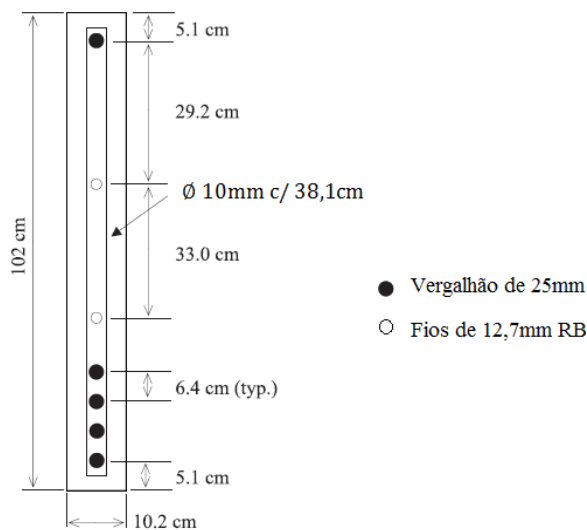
Viga C2A ensaiada por Hurff (2010)
